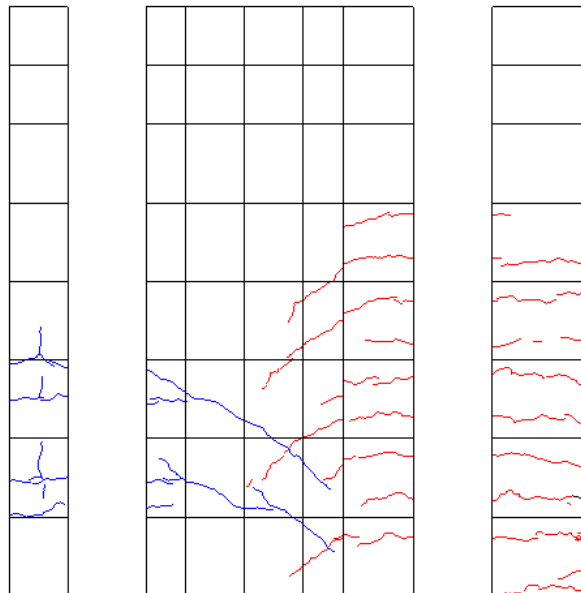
R=-1/400②ひび割れ図
